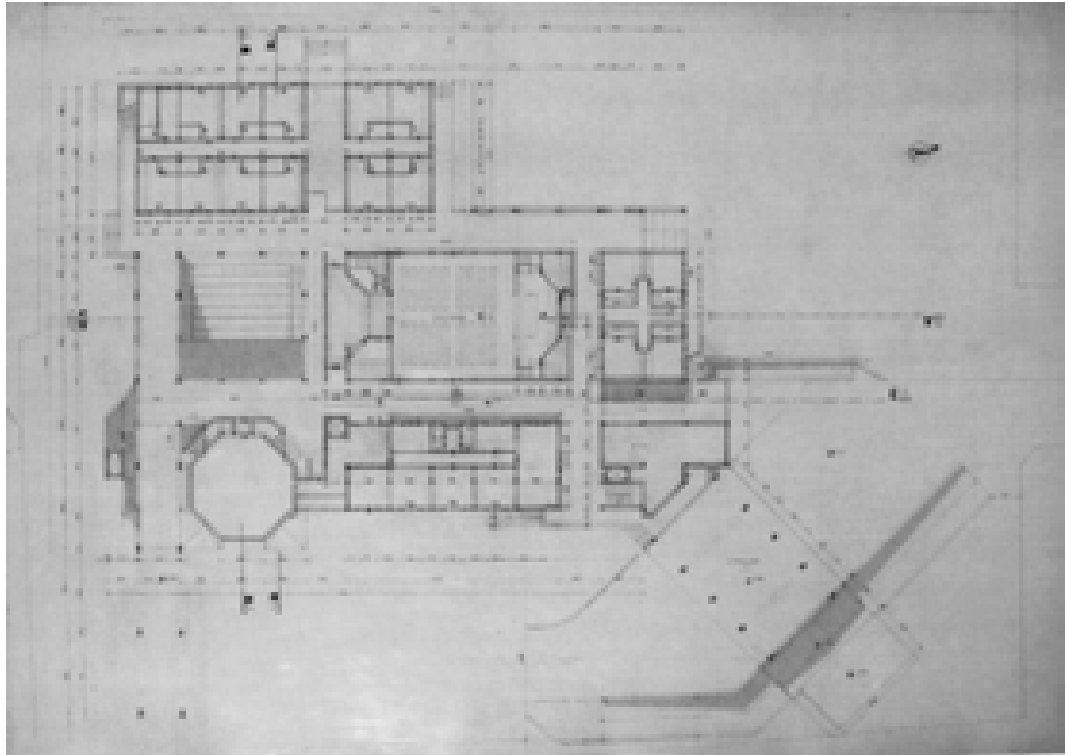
Pianta +1,00, stato futuro - 1989 (AABS-64_496)
